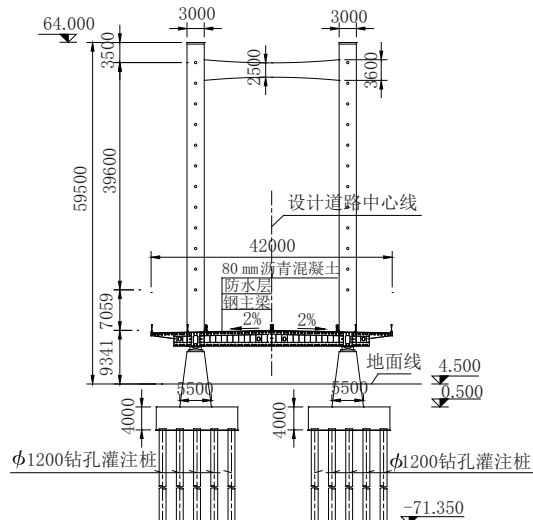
桥塔横断面布置图(单位:mm;标高为 m)
